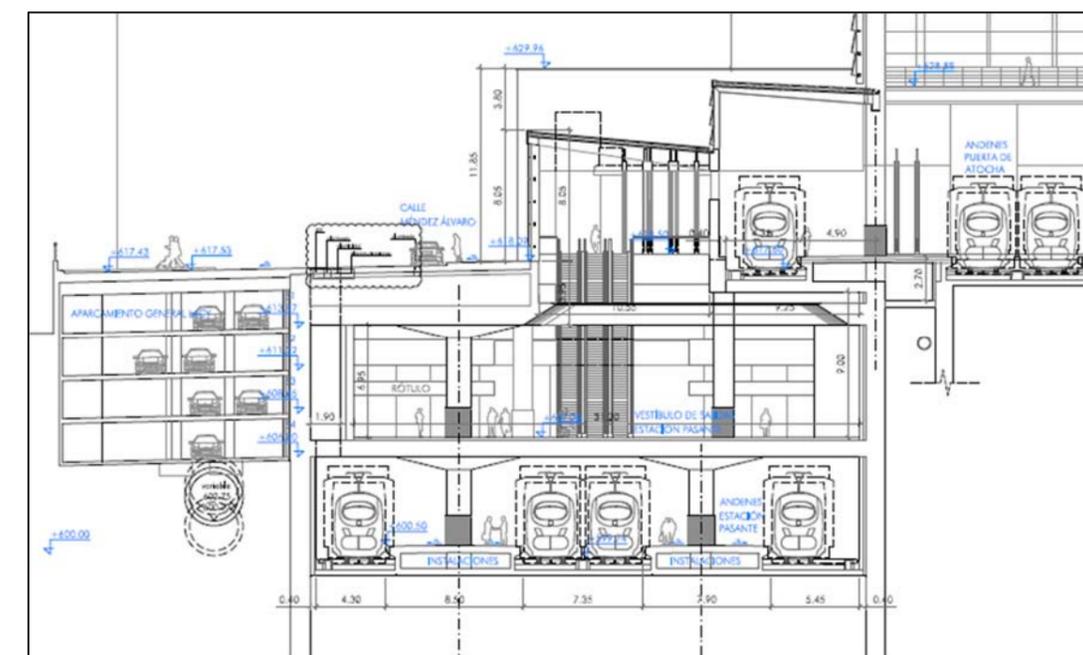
Estación Pasante. Sección por zona norte de losa nivel 607
